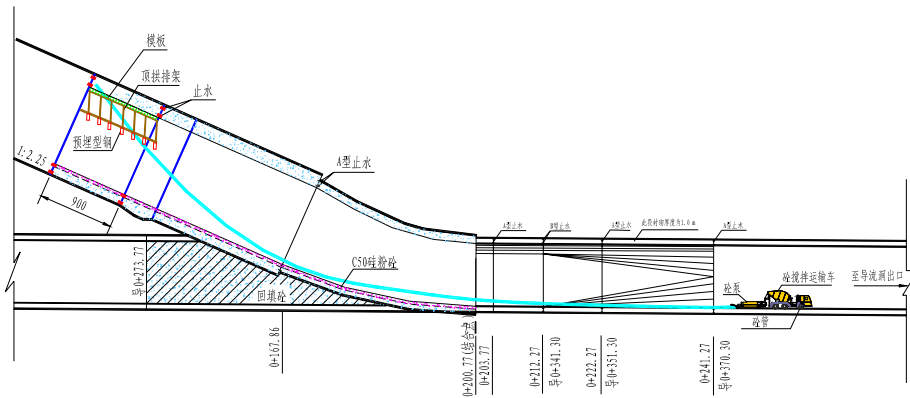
泄洪洞龙抬头反弧段砼衬砌施工示意图
